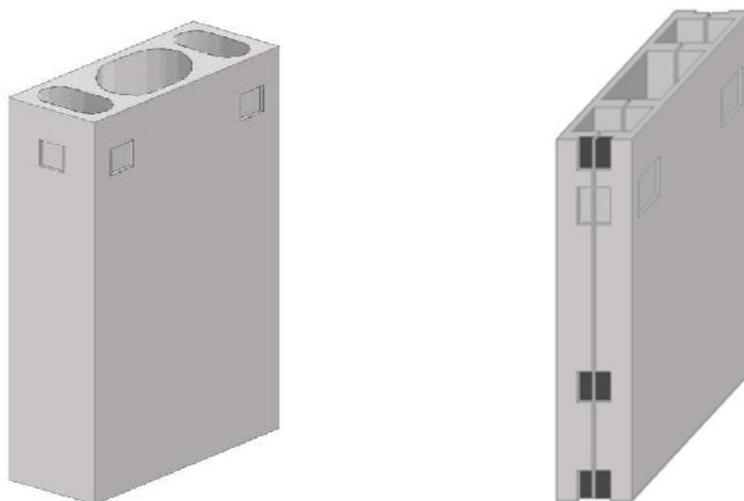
Вентиляционные блоки (вентблоки) железобетонные сборные и монолитные
